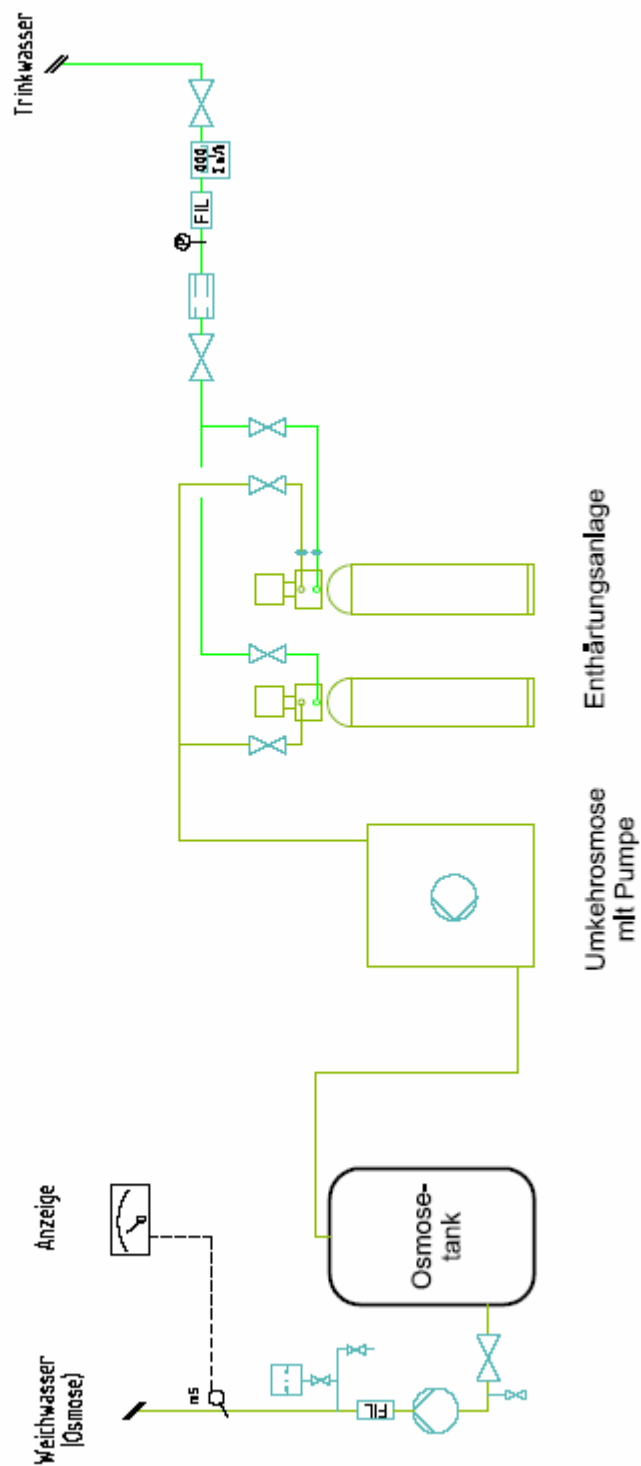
Anschlussschema Wasseraufbereitung
